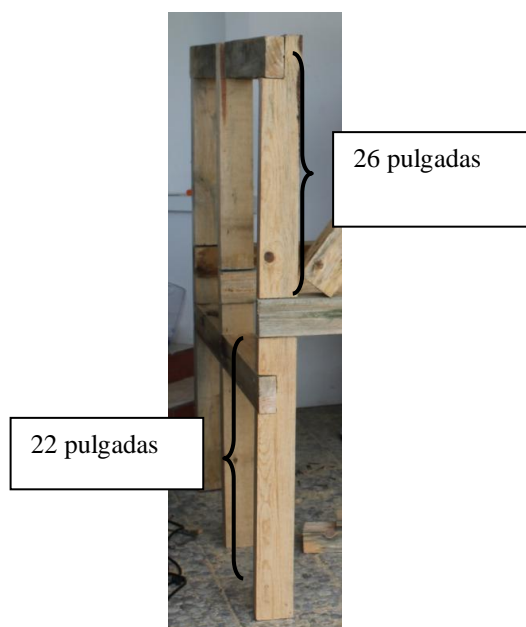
Distancia entre empalmes de viga tipo VI
